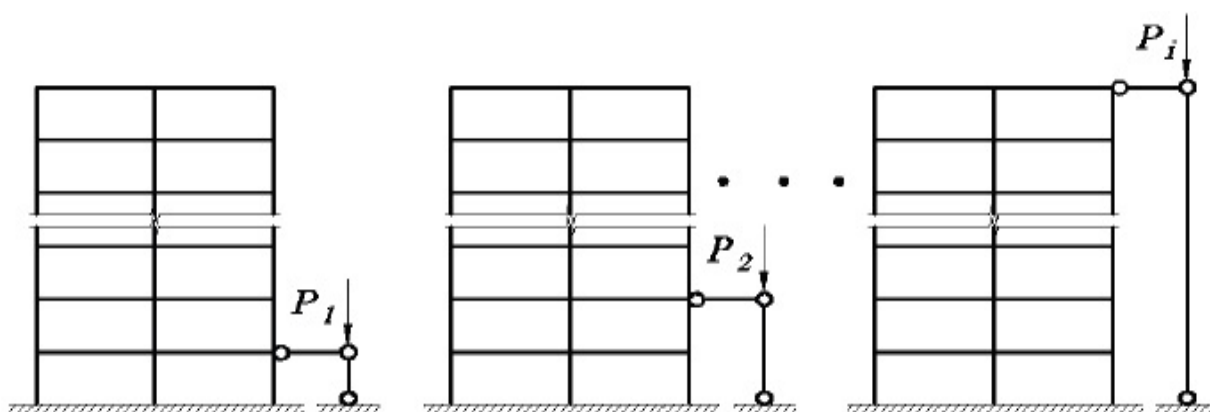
Принципиальная схема нагружения шарнирного стержня поэтажной нагрузкой рамы на примере 1-го, 2-го и i -го этажей
